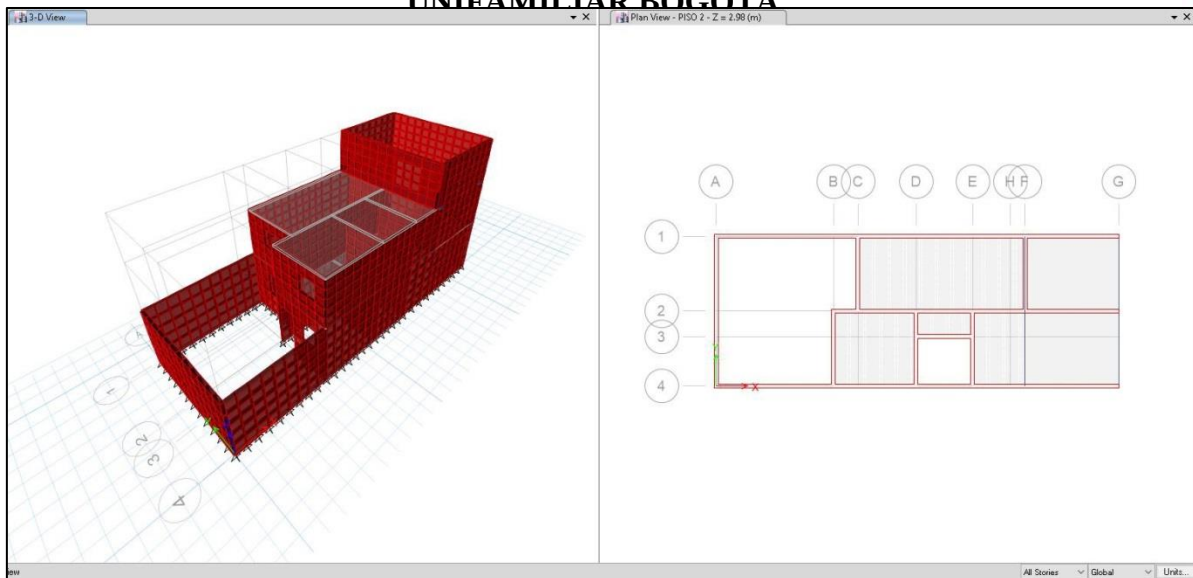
Modelo tridimensional vista 3D y Vista segundo nivel. Fuente propia
